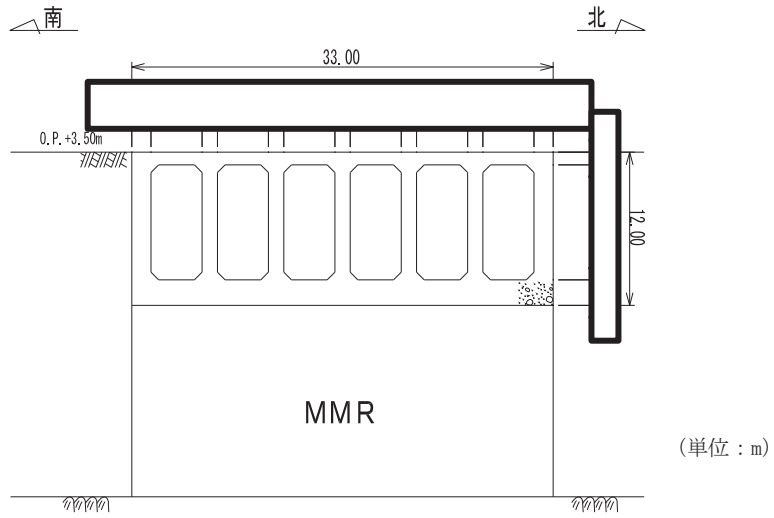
取水口断面図 (A-A 断面, 南北 (標準部))
